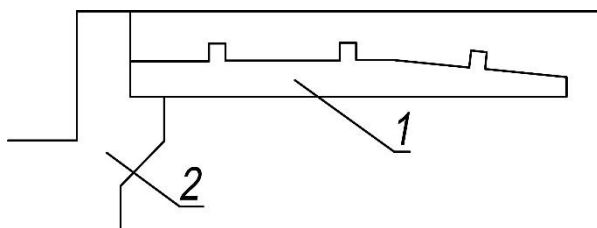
Сопряжение с использованием ребристой переходной плиты: 1- железобетонная плита; 2 – устой путепровода
